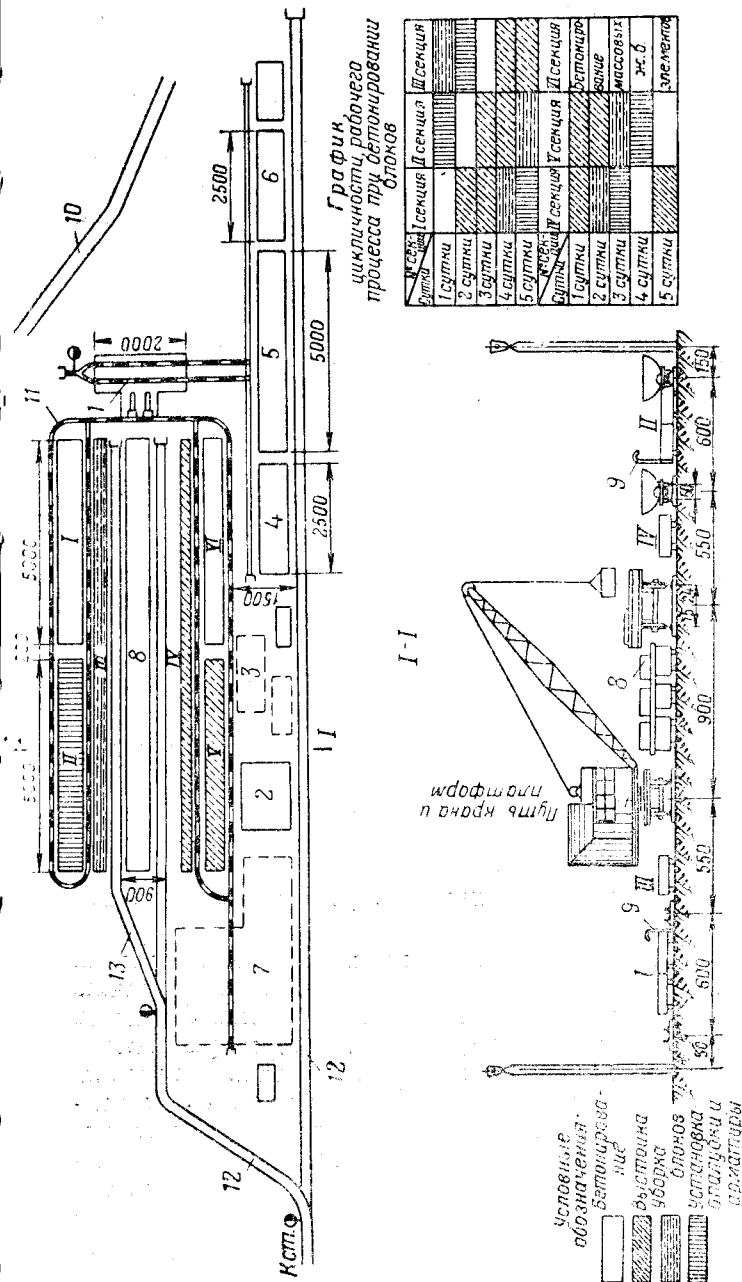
Схема полигона для изготовления блоков опор (римскими цифрами обозначены секции стендов для бетонирования): 1 — бетономесительная установка; 2 — опалубочные мастерские; 3 — арматурный цех; 4 — склад песка; 5 — склад щебня; 6 — склад цемента; 7 — склад лесоматериала; 8 — склад готовых блоков; 9 — водоразборные колонки; 10 — автодорога; 11 — узкоколейные пути; 12 — пути широкой колеи; 13 — крановый путь
